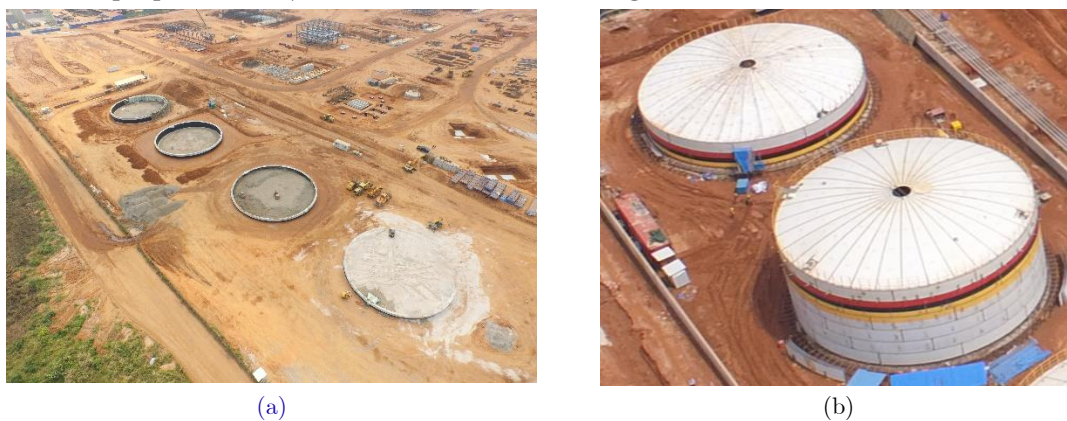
(a) Finalização do enchimento dos anéis de fundação com *tout-venant*; (b) Montagem dos tanques pré-fabricados de depósito de gasóleo.
